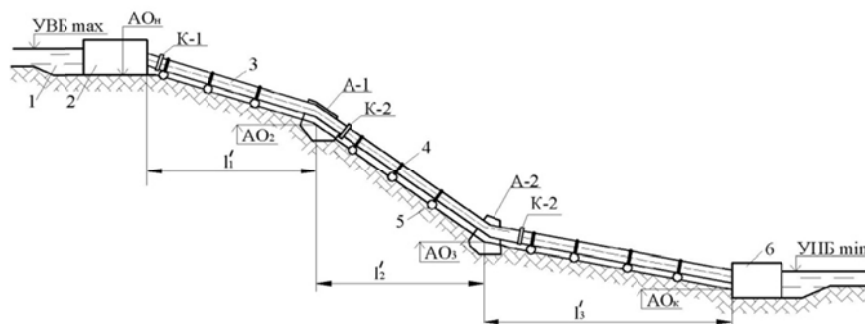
Схема компоновки трубопровода: 1 – напорный бассейн; 2 – водоприемник; 3 – трубопровод; 4 – опорное кольцо катковой промежуточной опоры; 5 – фундаментная часть промежуточной опоры; 6 – здание ГЭС; А-1, А-2 – анкерные опоры 1 и 2; К-1, К-2, К-3 – температурно-осадочные компенсаторы; АО_н, АО₂, АО₃, АО_к – отметки опор трубопровода; l'_1, l'_2, l'_3 – горизонтальные расстояния между отметками АО_н ... АО_к
